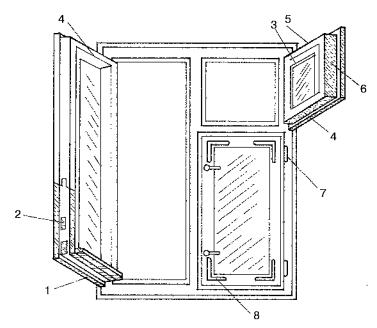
Оконный переплет: 1 — прокладка; 2 — брусок обвязки; 3 — штапик; 4 — отлив; 5 — верхний брусок форточки; 6 — боковой брусок форточки; 7 — петля; 8 — угольник
